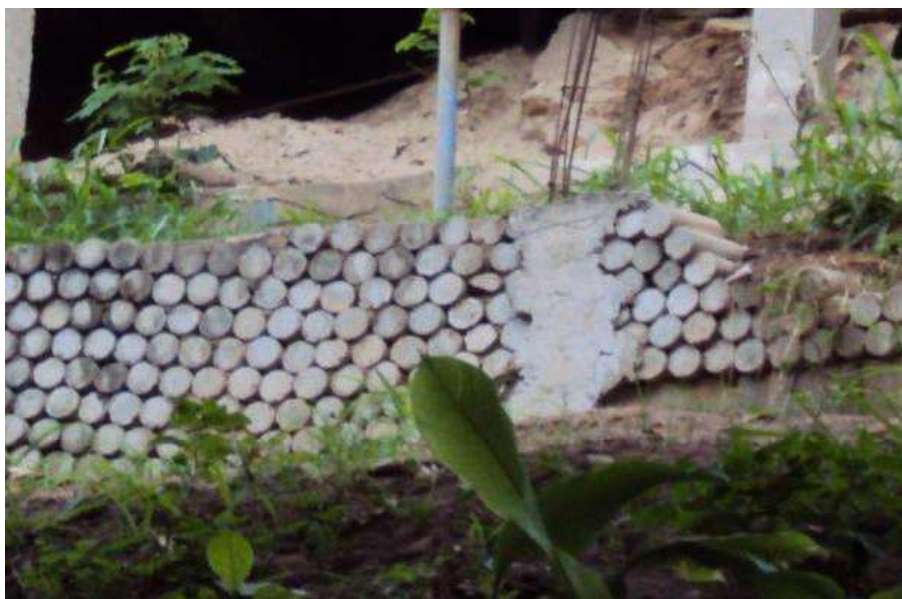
Contenção do terreno construída com corpos de prova de concreto.
